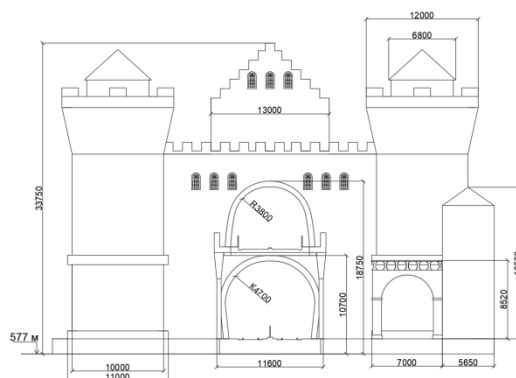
Архитектурно-планировочное решение (фасад - южный)
